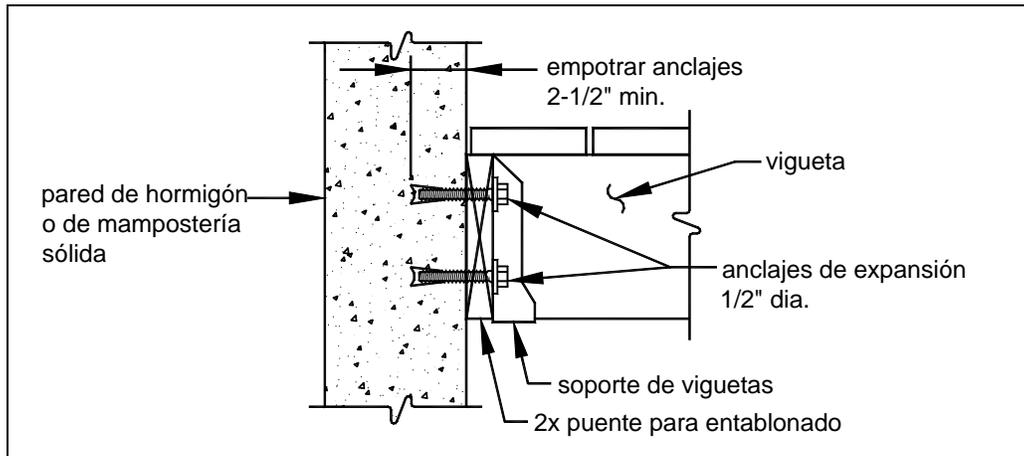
UNIÓN DEL PUENTE PARA ENTABLONADO CON LA PARED DE CIMENTACIÓN (HORMIGÓN O MAMPOSTERÍA SÓLIDA)
